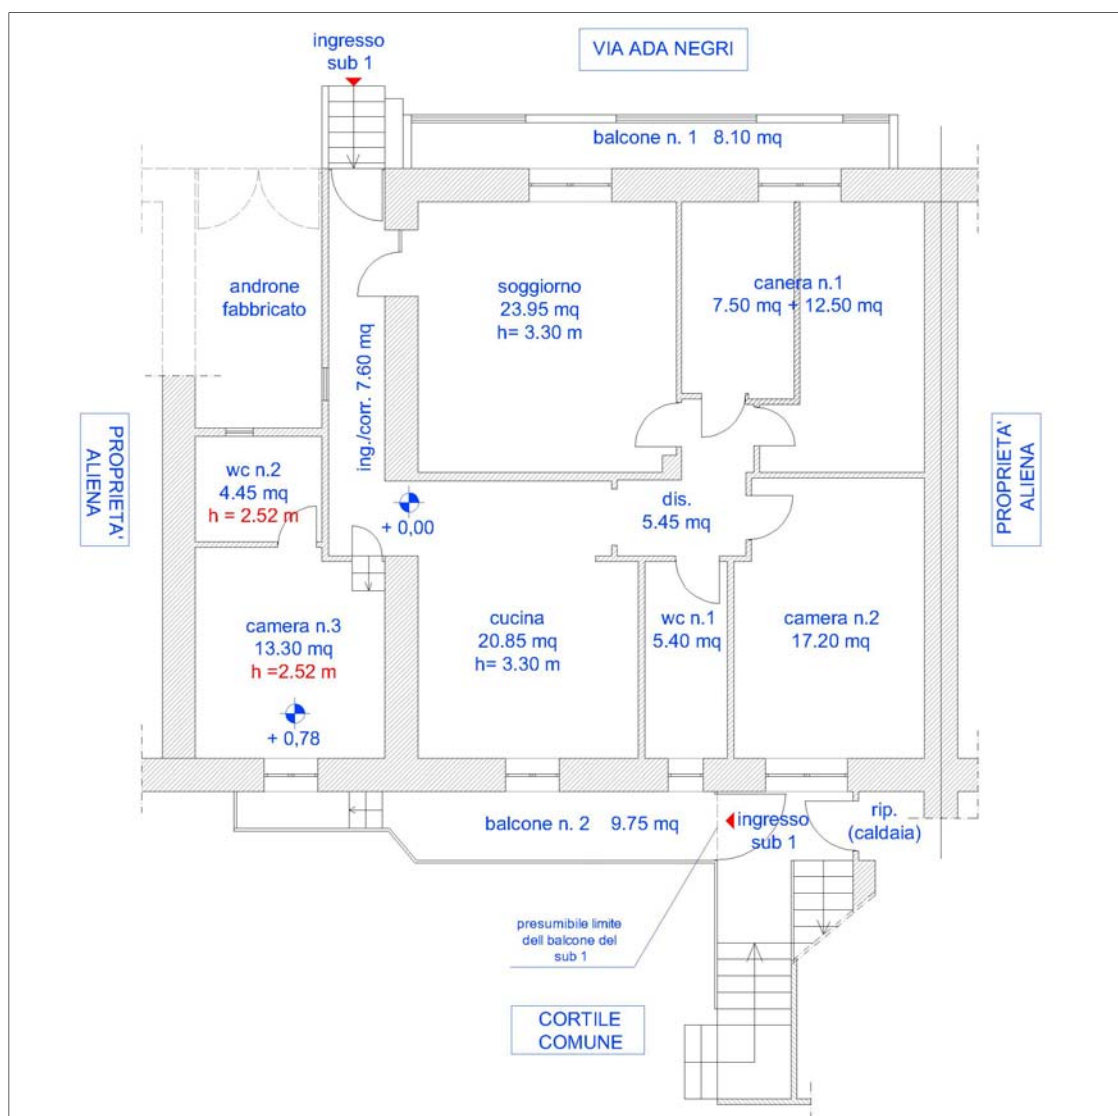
Planimetria stato dei luoghi del 13/12/2023
